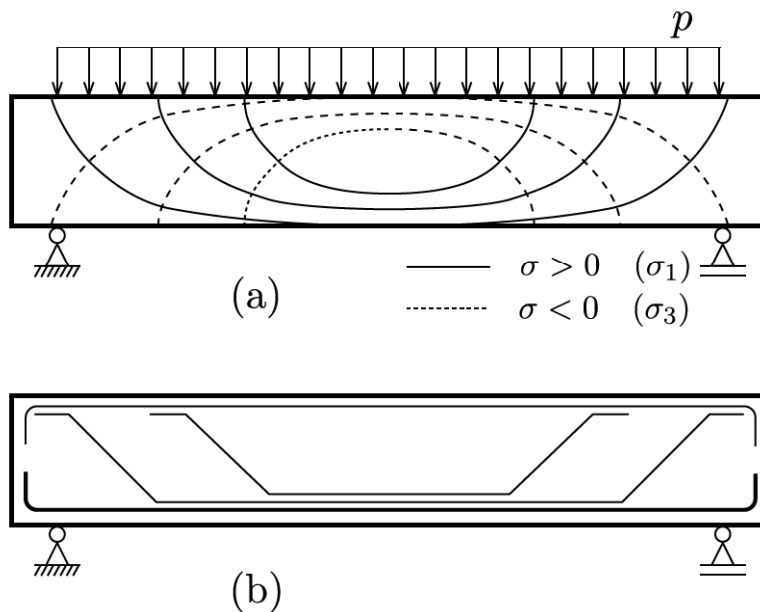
Trajetórias das tensões principais σ_1 e σ_3 para uma viga submetida a uma carga uniformemente distribuída: (a) trajetórias; (b) distribuição da armadura numa viga de concreto armado.
